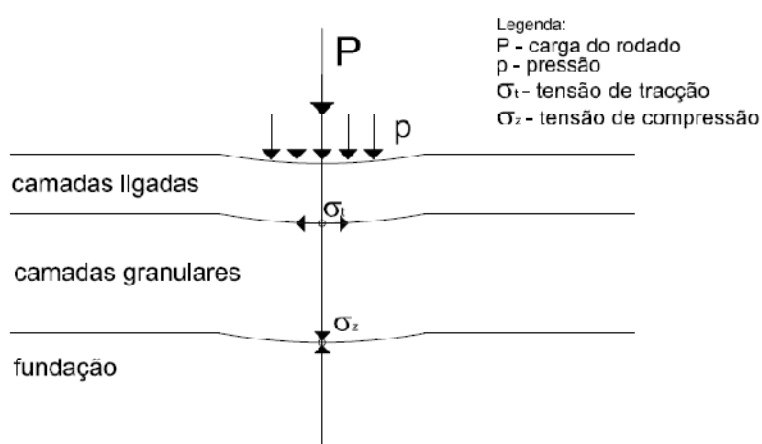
Estrutura tipo de um pavimento rodoviário (Picado-Santos et al. 2006b)
